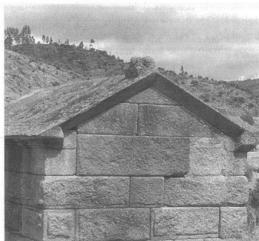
Fotografía detalle de cubierta y cornisa del alzado sureste (Liz Guiral 1988)
